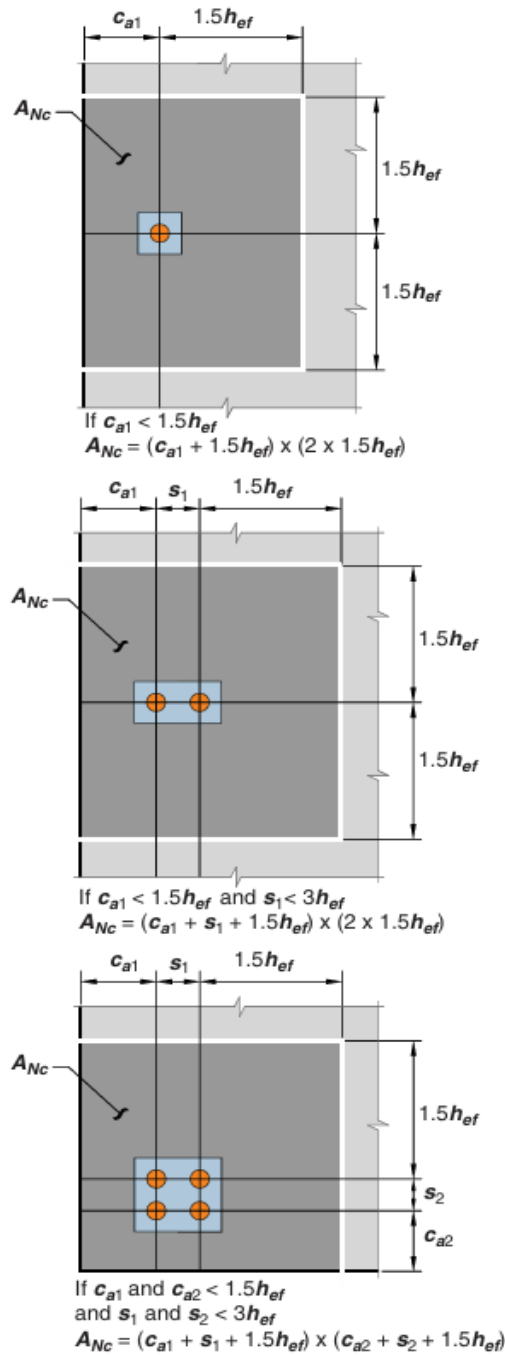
Cálculo de A_{Nc} para anclajes individuales y grupos de anclajes. Tomado de Building Code Requirements for Structural Concrete (ACI 318-19), por American Concrete Institute, 2019. Copyright 2019 por American Concrete Institute.
